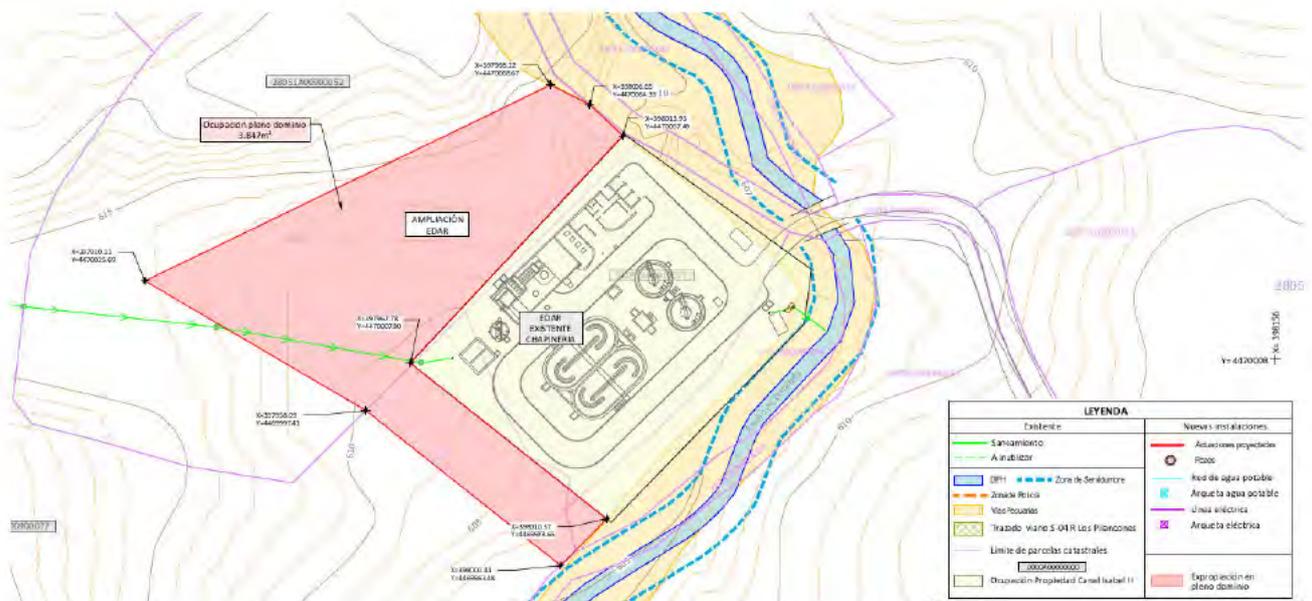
Plano en planta de la ampliación de la EDAR. Fuente: Elaboración propia.
